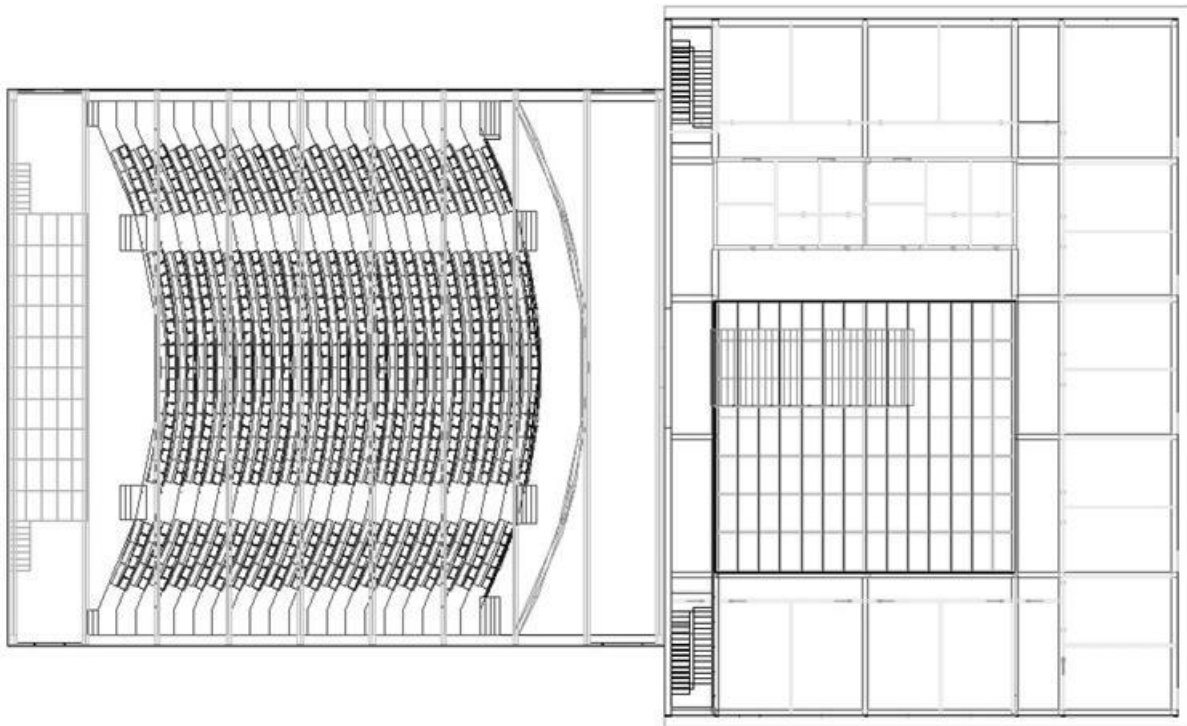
Grundriss des Hörsaal- und Bürogebäudes
